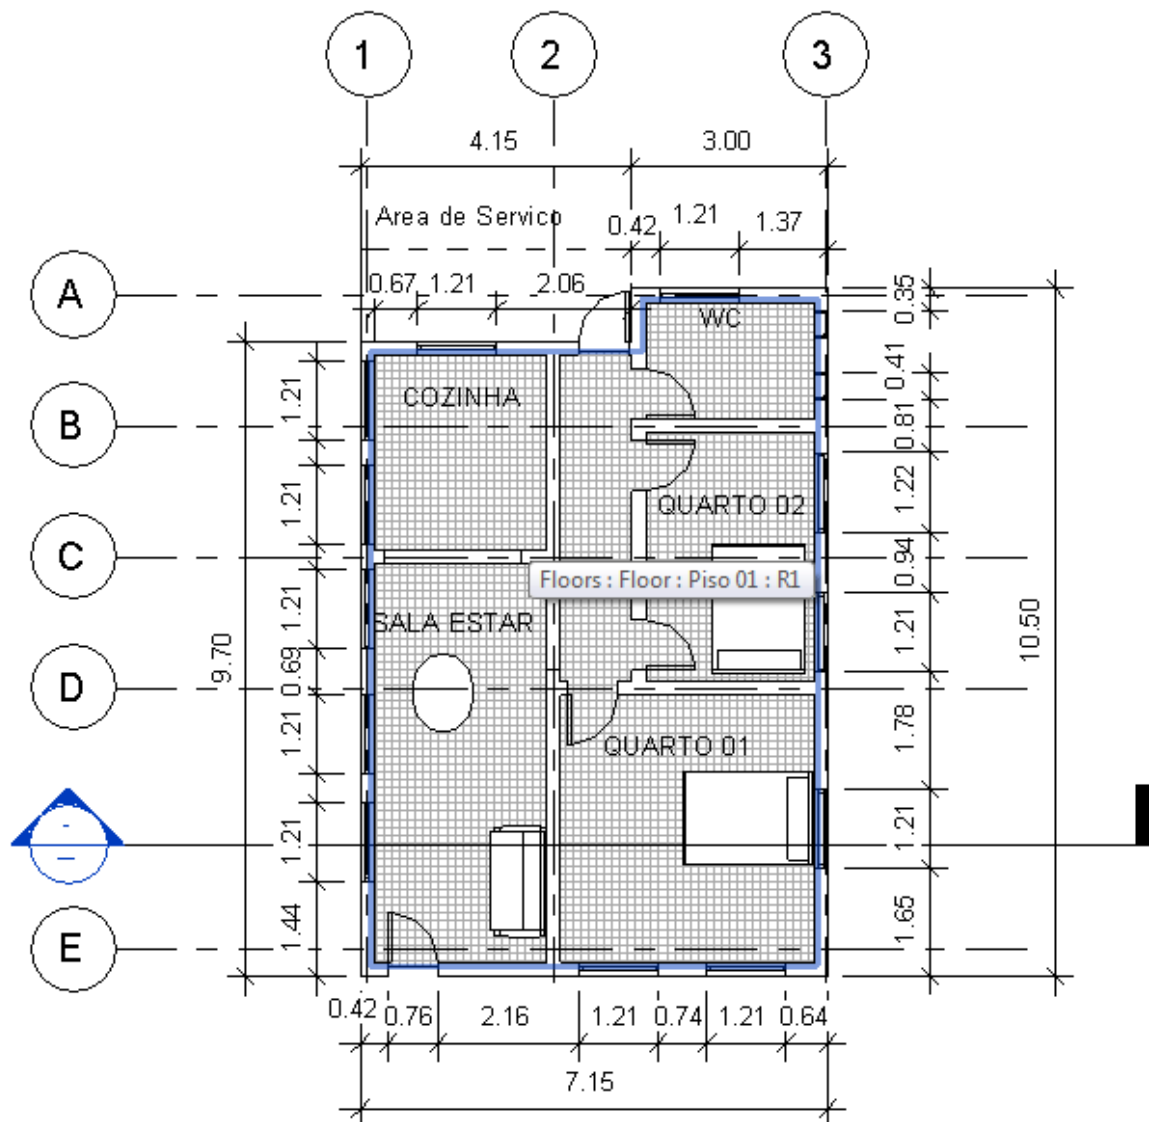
Detalhe da Planta-baixa casa Lorenzo
